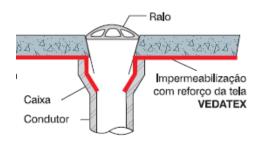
Detalhe da impermeabilização e grelha dos ralos
